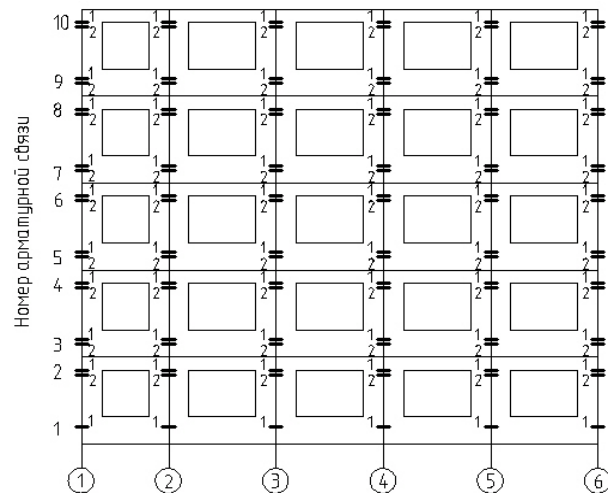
Схема фасада здания серии 1-480 с арматурными связями узловых соединений и элементами усиления при коррозии арматурных связей на 70%. 1 – арматурные связи; 2 – элементы усиления / The scheme of the facade of the building with steel ties nodal connections and reinforcements from corrosion of reinforcing ties 70%
